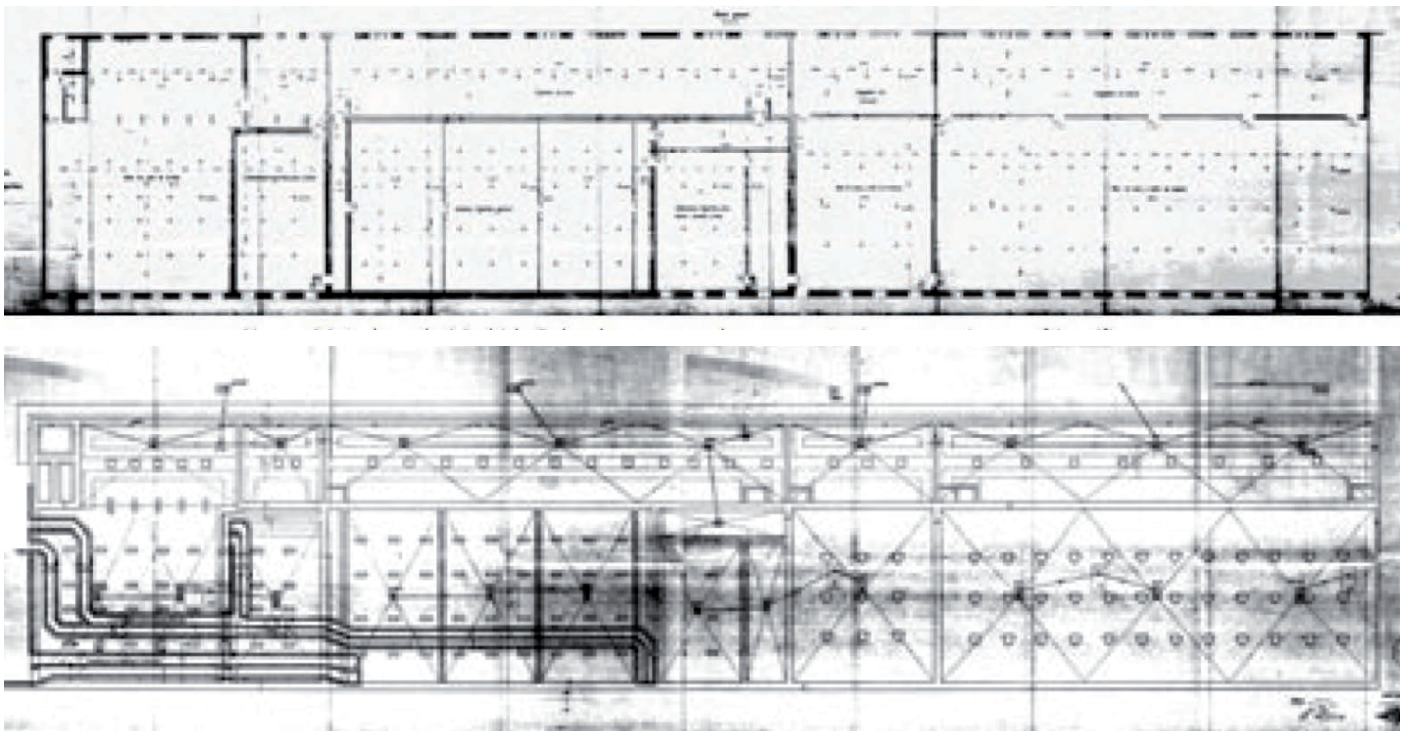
\_ Reproducción de los planos originales de la nave 17: colgaderos y naves de oreo, antacámaras y cámaras frigoríficas, planta principal y planta de subsuelo (galería instalaciones)
